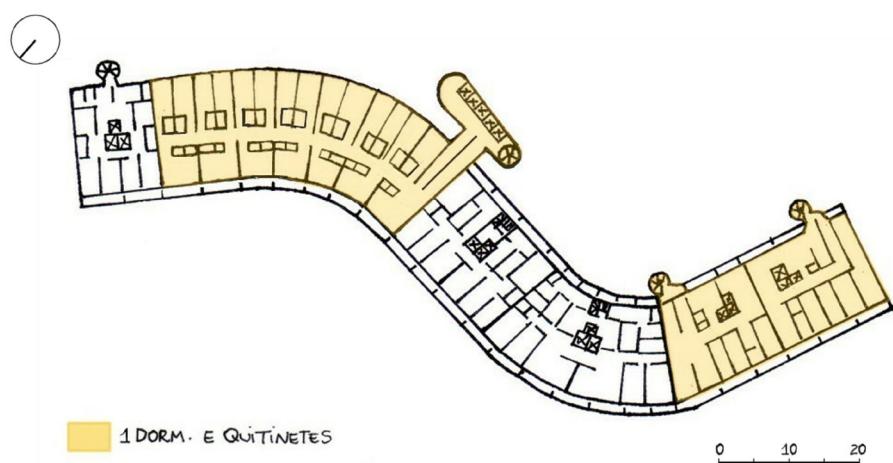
Reprodução da planta do Pavimento tipo do Edifício Copan.
